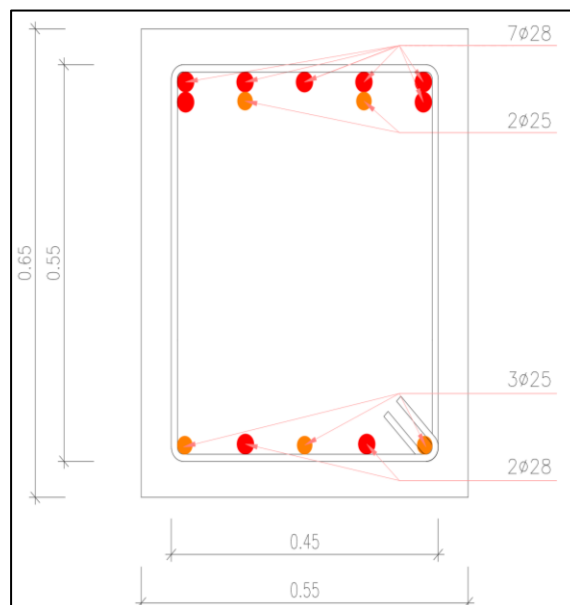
Armado de la viga para momentos negativos en el segundo tramo. Fuente: Autor
